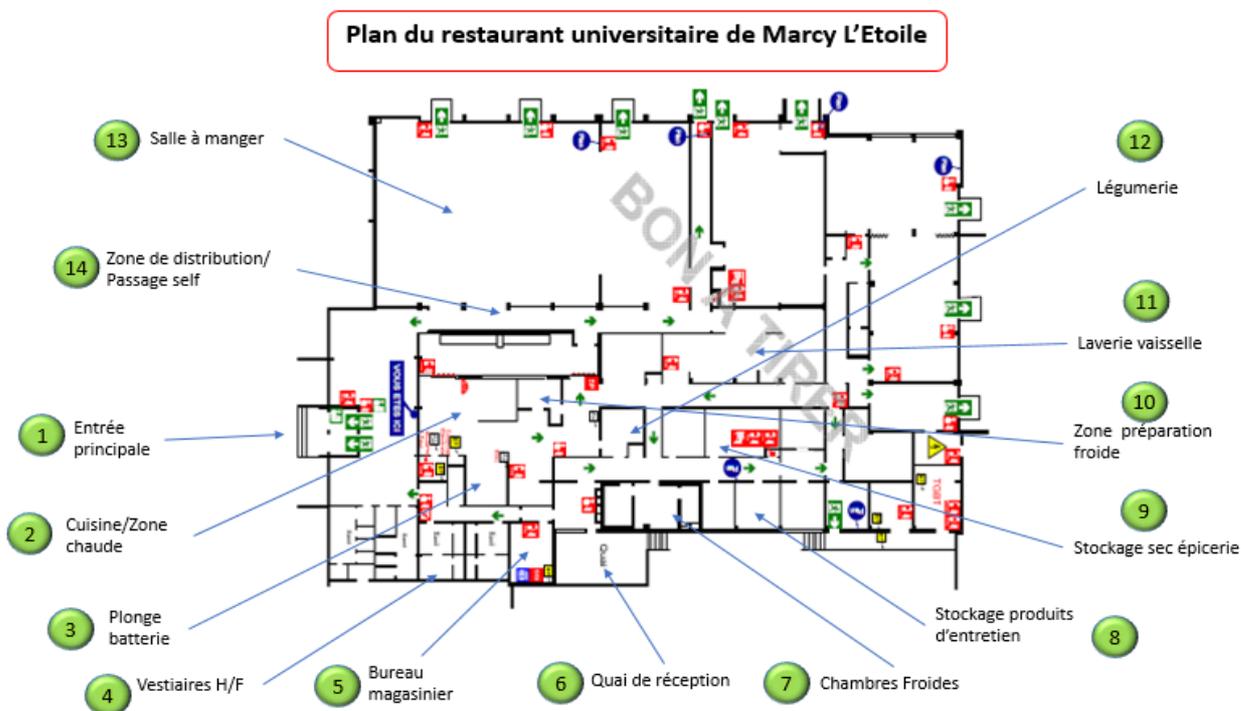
Plan du restaurant universitaire de Marcy l'Etoile
